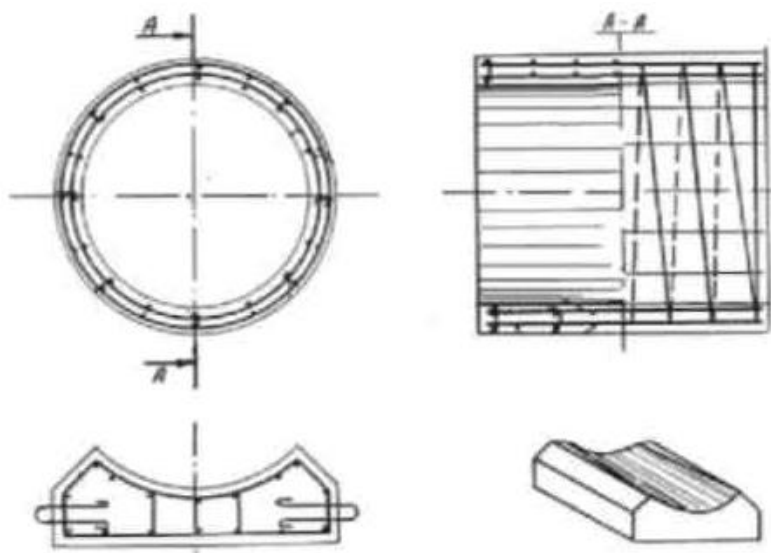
Конструкція залізобетонної водопропускної труби круглого перерізу
